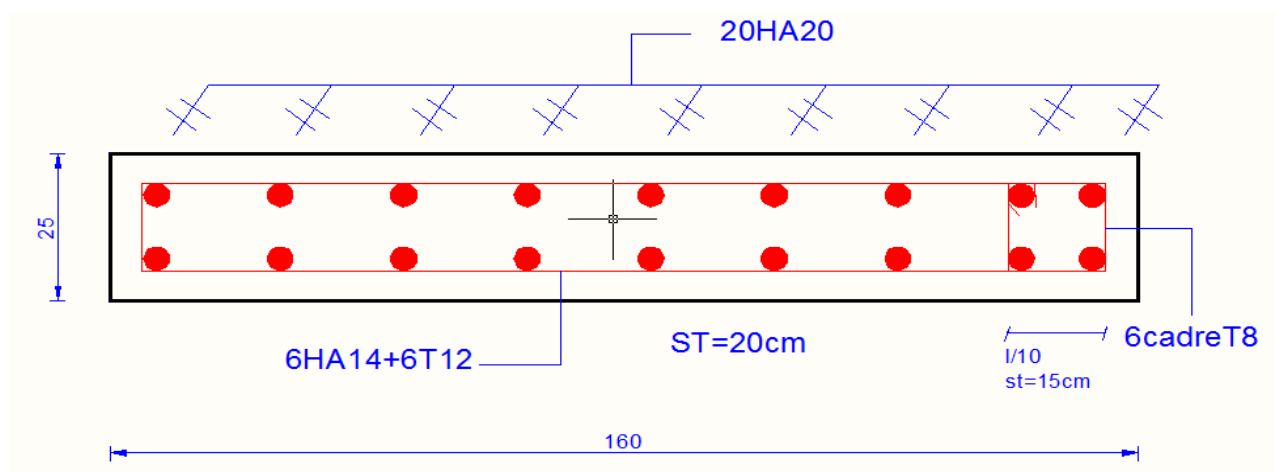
ferrailage du Voile VX4 de (Soupente au 1<sup>ème</sup>) étage
